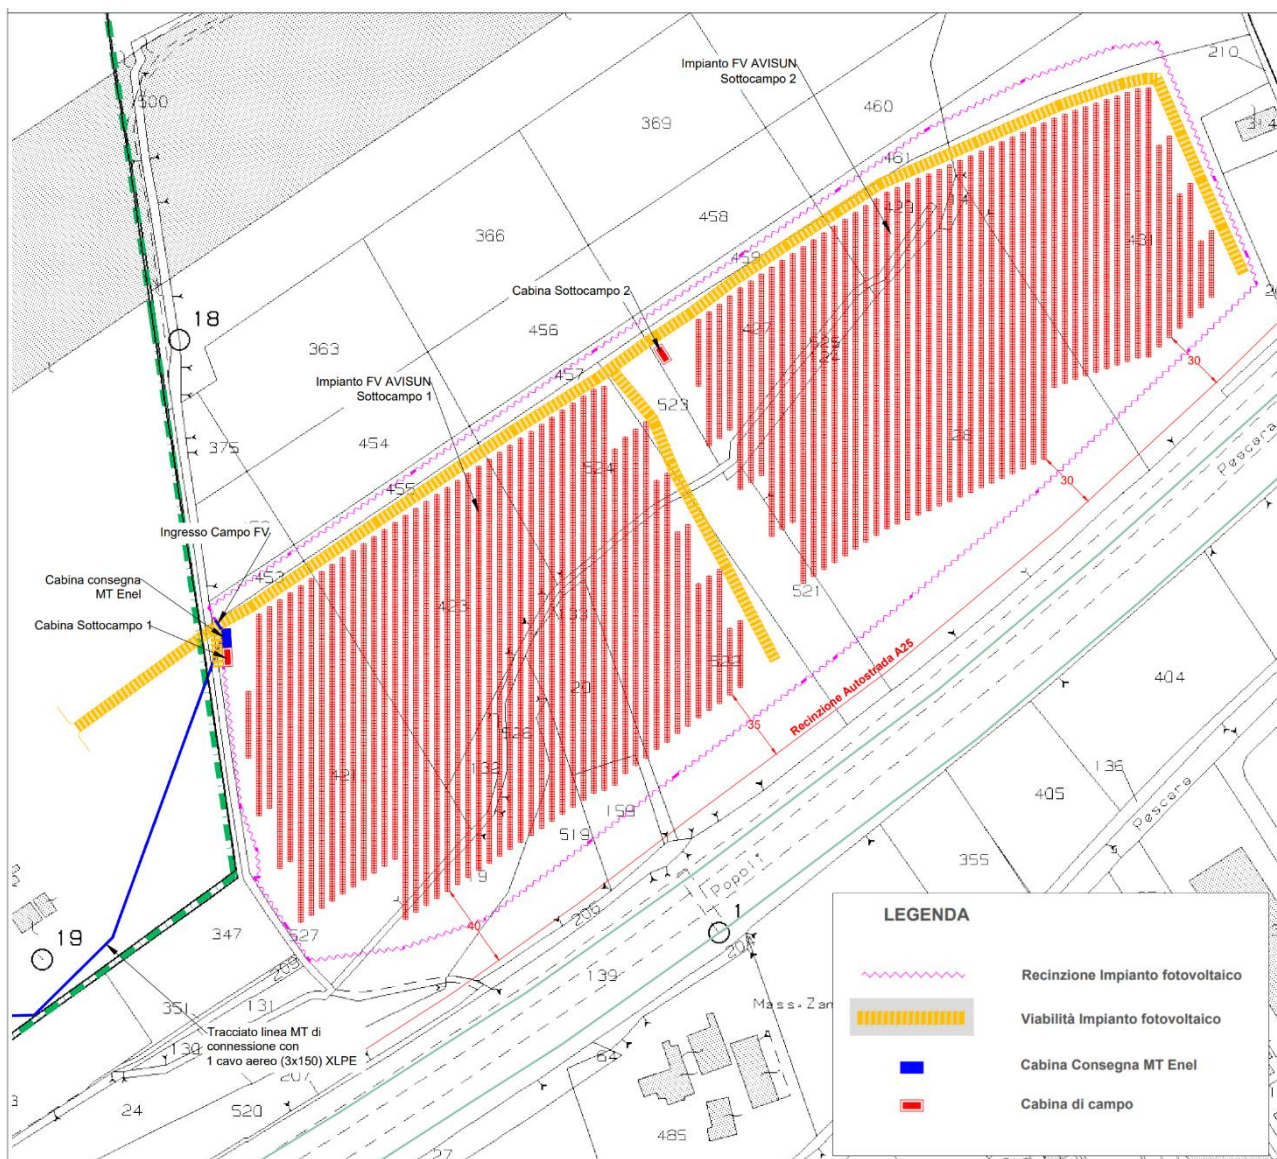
Layout parco fotovoltaico da progetto autorizzato
